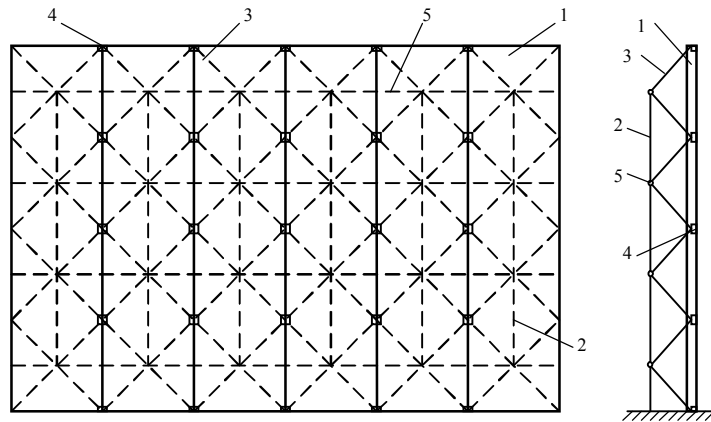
Вертикальна стіна з окремих лінійних сталезалізобетонних елементів: 1 – залізобетонна плита; 2 – вертикальний сталевий пояс; 3 – сталеві розкоси; 4 – закладна деталь для з'єднання залізобетонних плит; 5 – стрижень для з'єднання елементів структури.
